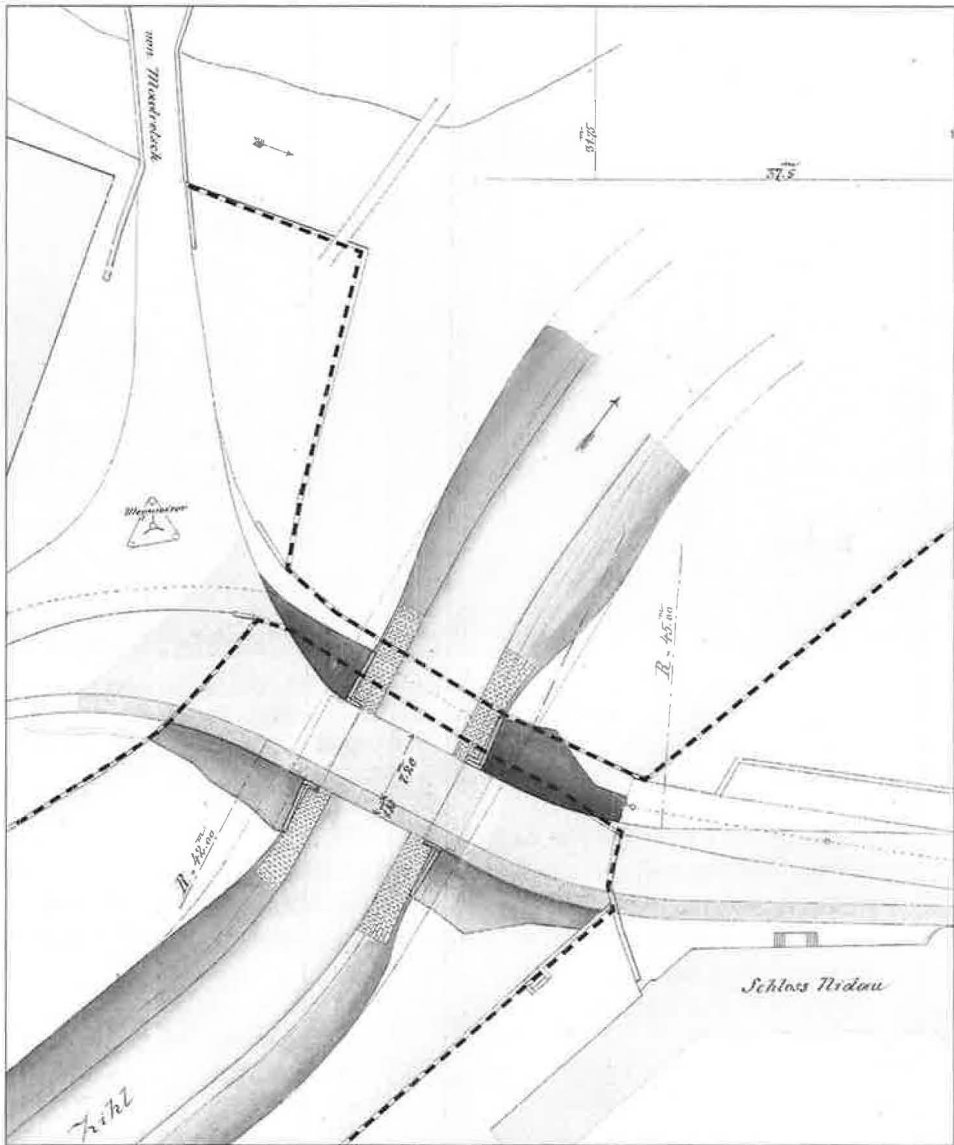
Situationsplan (verkleinert) STAB BB 10 4.128. In der Bildmitte die 1877 neu erstellte Schlossbrücke über die alte Zihl. Konstruktion: eiserne Bogenfachwerkbrücke, 9 m breit, 12 m lang. Der verschmälerte Flusslauf der alten Zihl ist bei der Schlossbrücke noch zusätzlich eingeeengt. Hans Funk*: ... «U wo die erschti Juragewässerkorrektion cho isch, hei si d'Zihl schmeler gmacht u dört bi dr Schlossbrügg vil z'schmal. Dasch doch blöd, wenn me ne Fluss bire Brügg duet y-änge.» Gestrichelt eingezeichnet ist der alte Flusslauf der Grossen Zihl vor dem Bau des Nidau-Büren-Kanals und die 1877 abgebrochene Zugbrücke, welche am südlichen Rand der neuen Brücke verlief, Länge ca. 43 m, Breite ca. 4.2 m.
